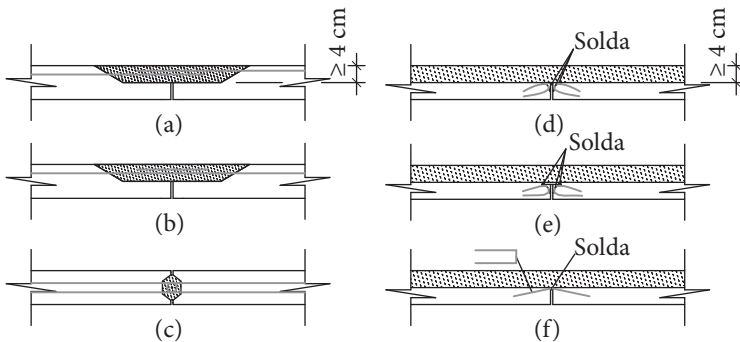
Detalhe de ligação entre painéis de lajes pré-moldadas.
